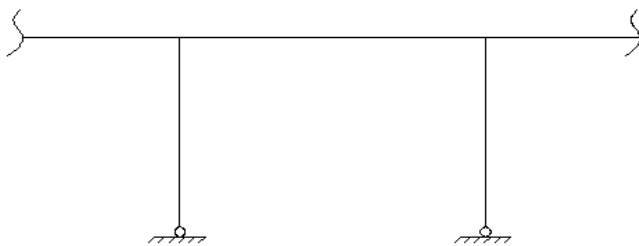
Шарнірне кріплення колон до фундаментів.
